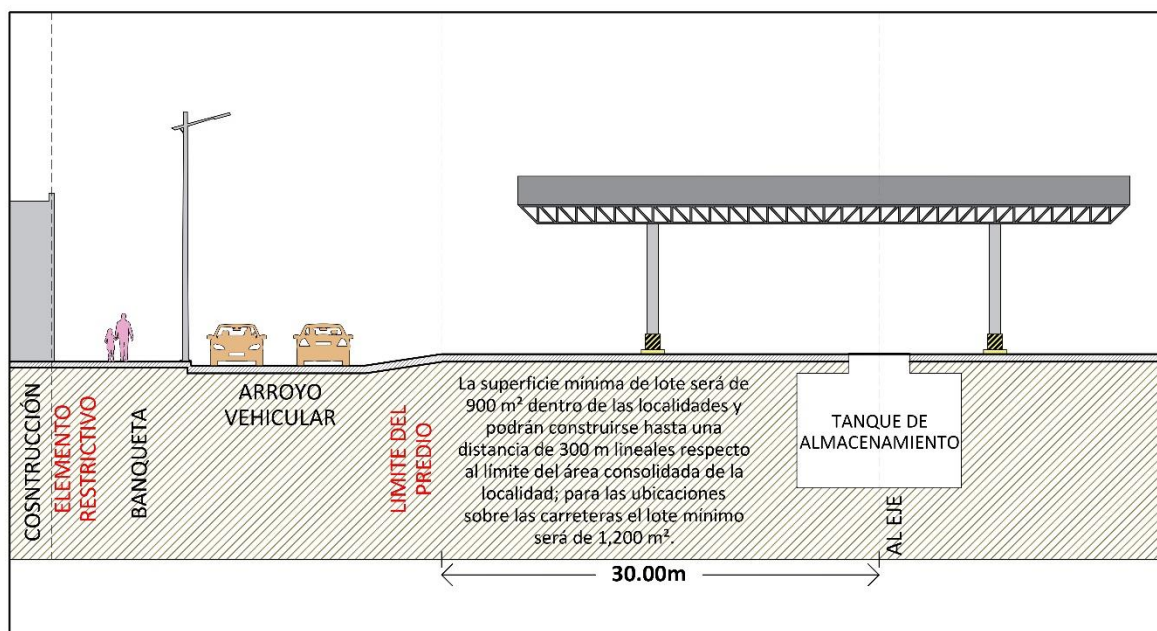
Elementos restrictivos para la construcción de estaciones de servicio y de autoconsumo.
